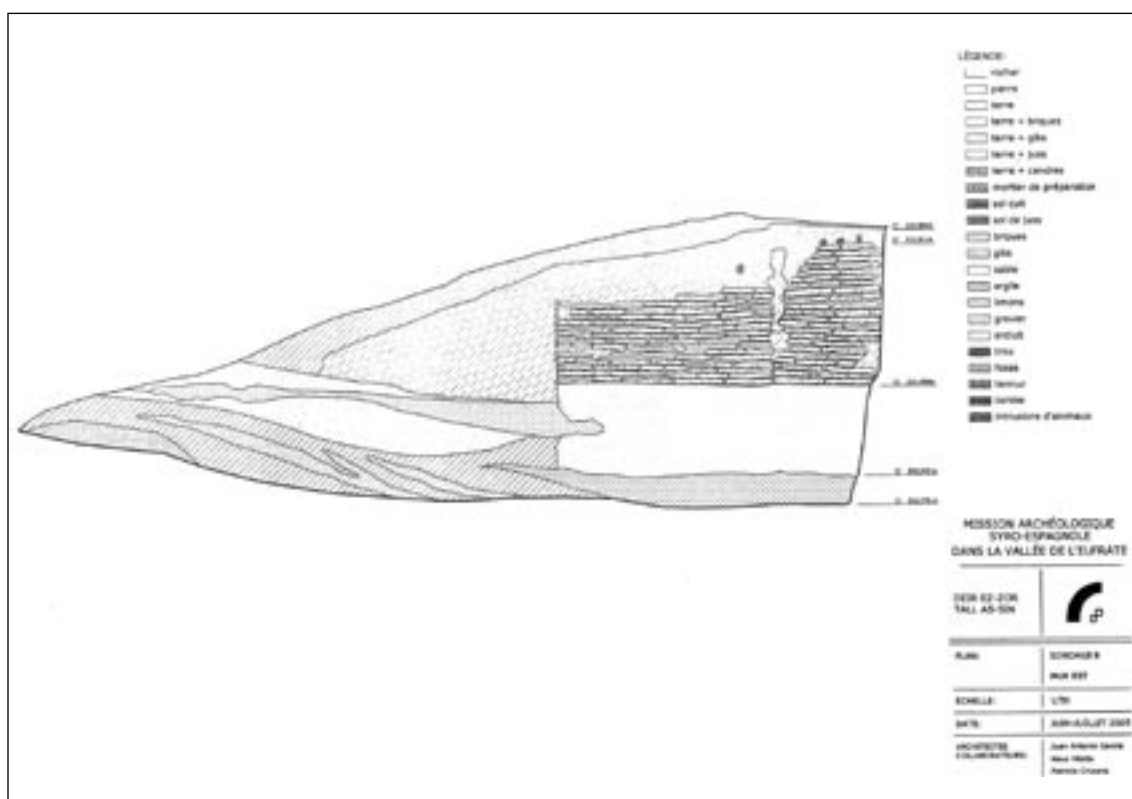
Sondagem B: torre da muralha bizantina (P. Cruzans, N. Vilalta e J. A. García).
